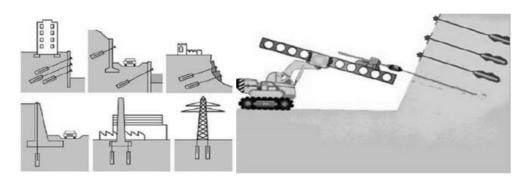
Принципиальная схема устройства грунтовых анкеров
